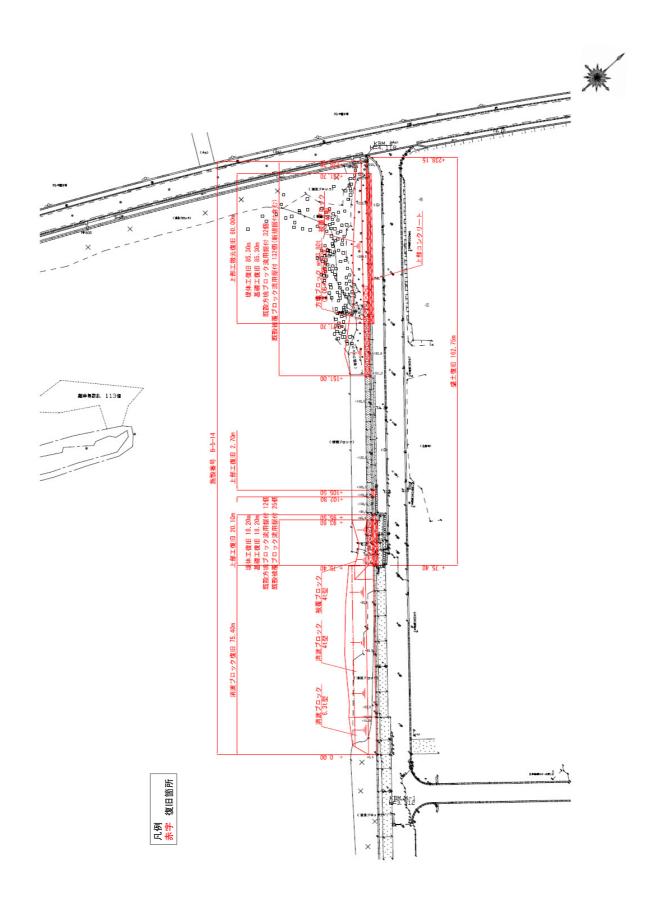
No.1 半崎地区_1 号護岸平面図(復旧後)
